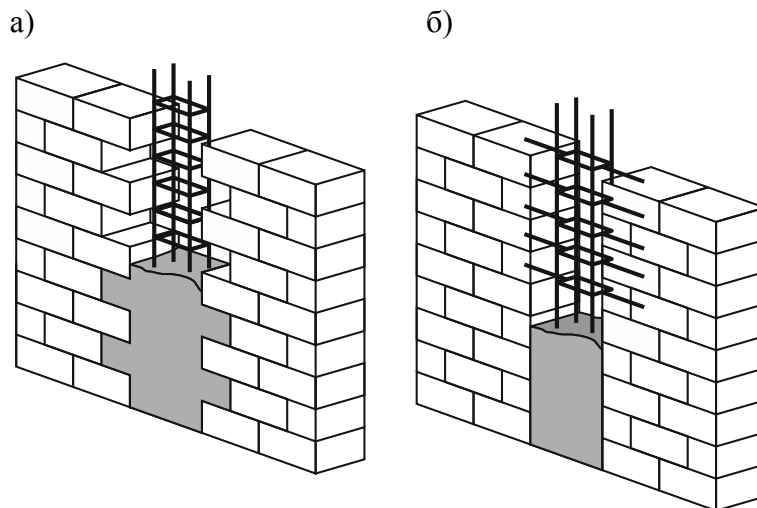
Армирование каменных стен вертикальными железобетонными вставками соединенными с кладкой с помощью штрабы (а) и металлических анкеров (б) [3]
